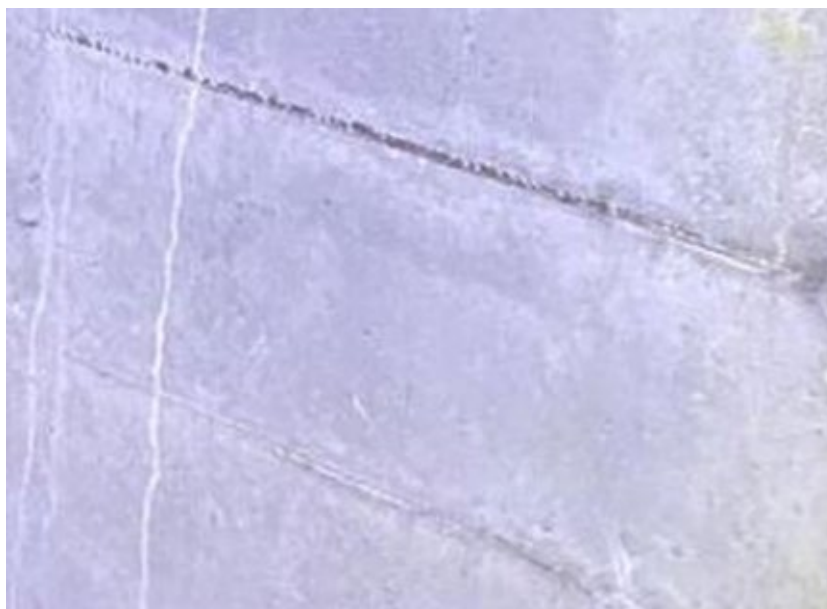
Отсутствие защитного слоя бетона с оголением и коррозией арматурных стержней
